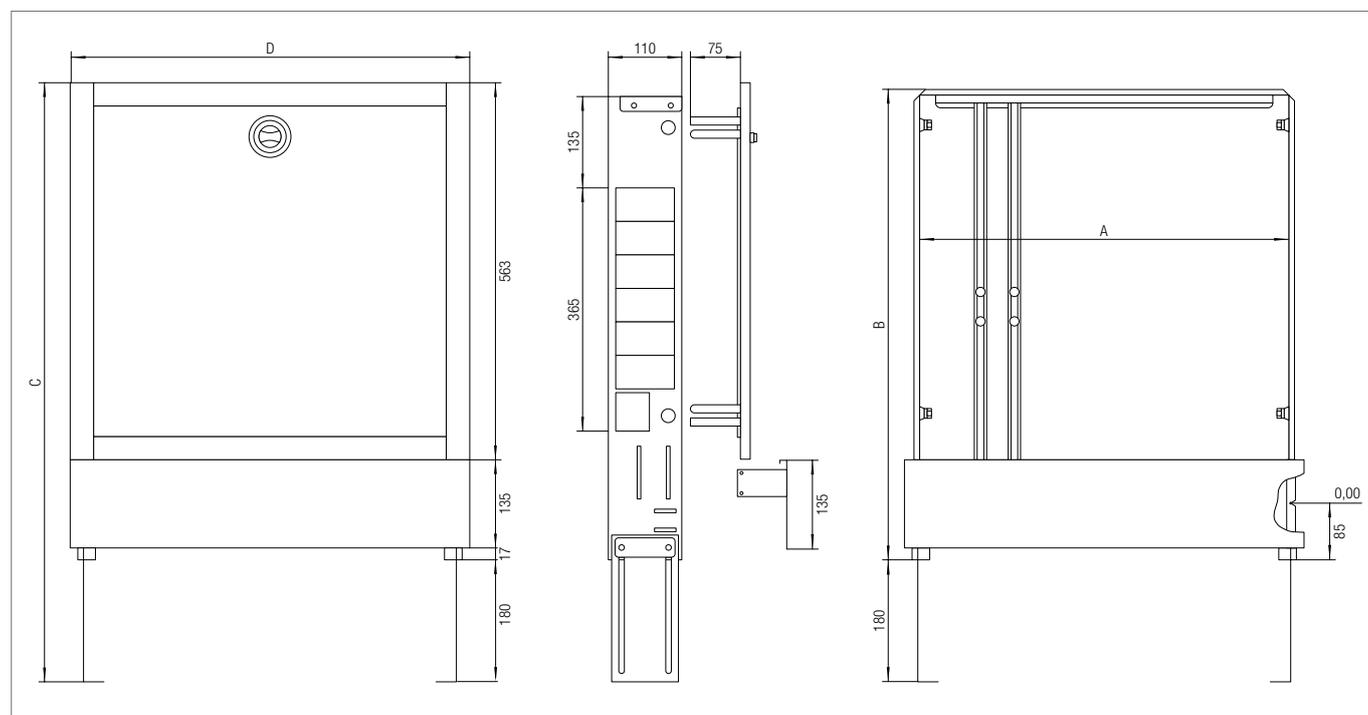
Dimensions coffret pour collecteur UP 110
